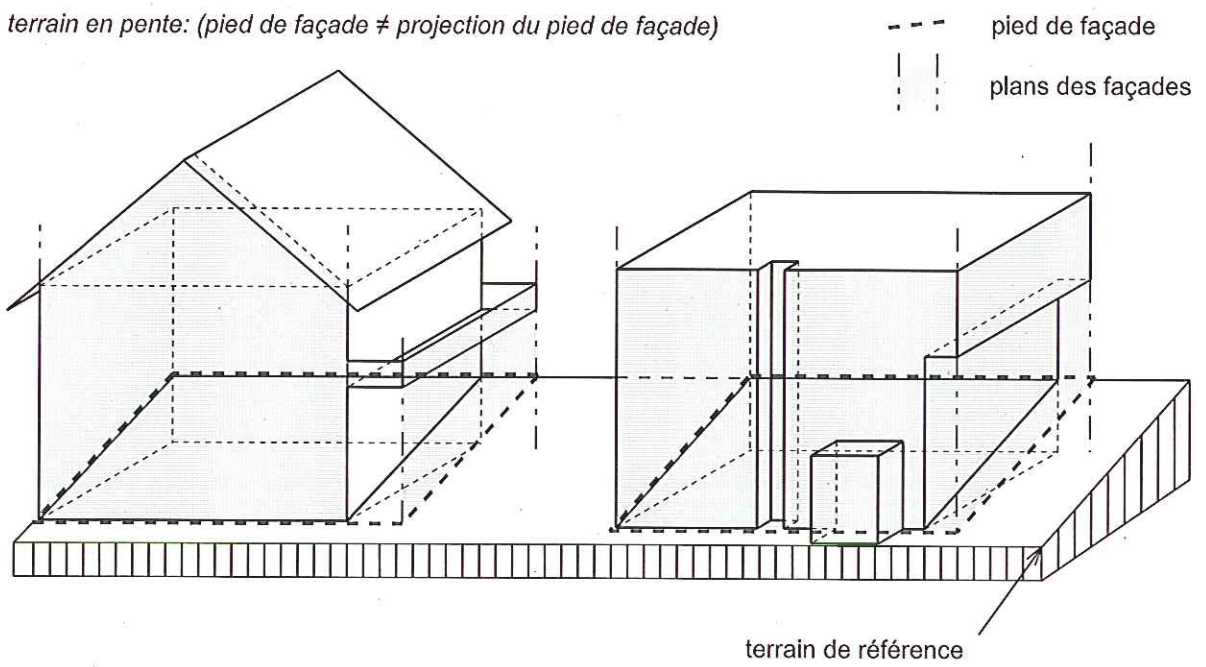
3.3 Plans des façades et projection du pied de façade
